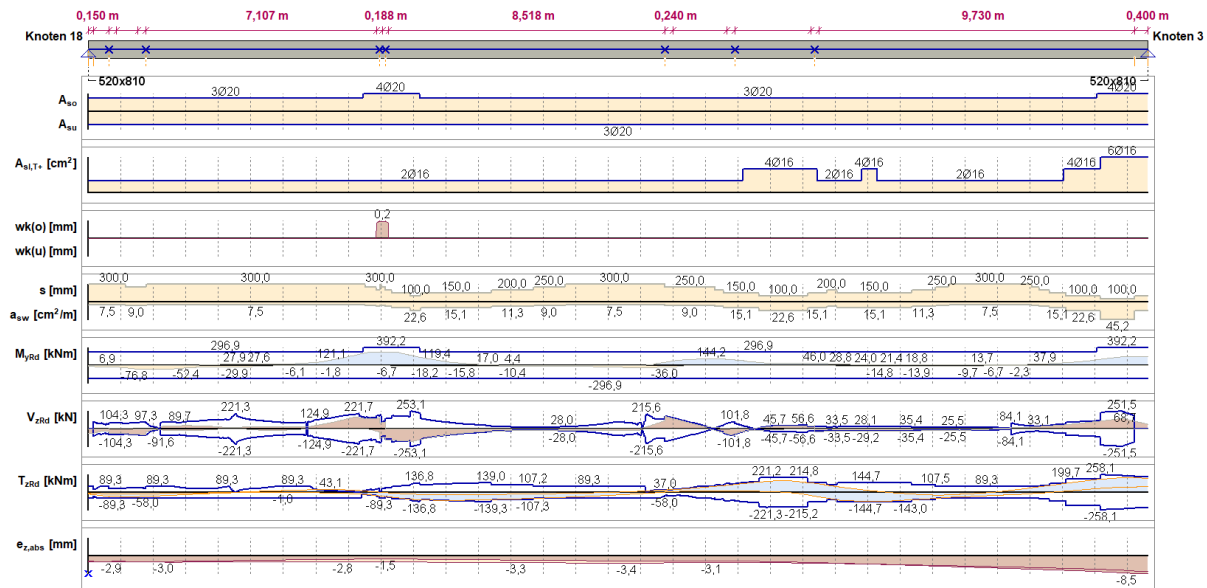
Berechnete Balkenbewehrung Querschnitt 520x810 (Achse 5)
